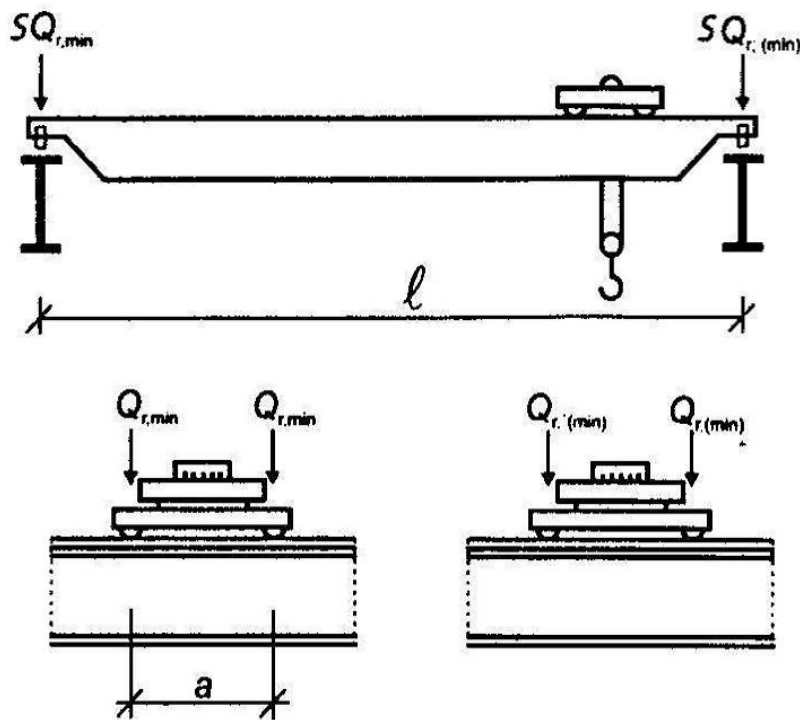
Charges verticales minimales sur la poutre de roulement
